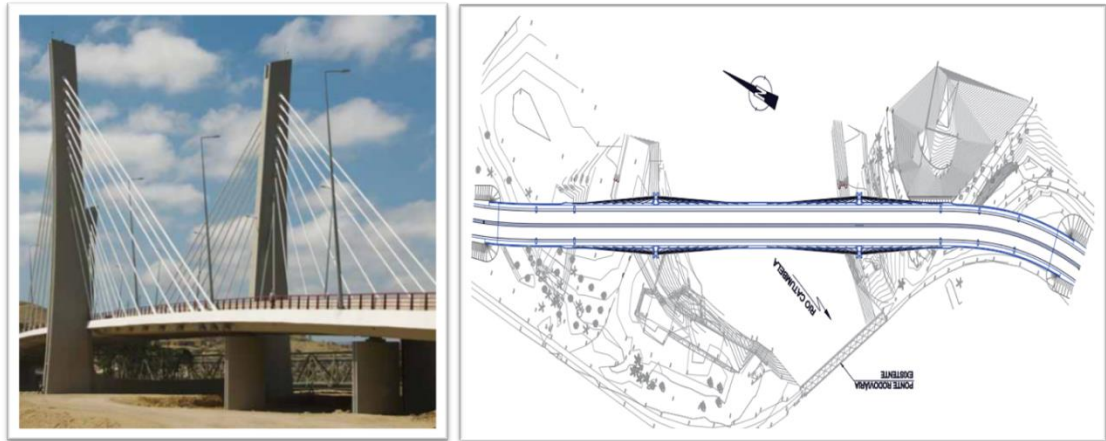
Torre em "U" e Planta da Ponte 4 de Abril (Fonte: livro “Ponte 4 de Abril. Nova Ponte sobre o rio Catumbela”)
